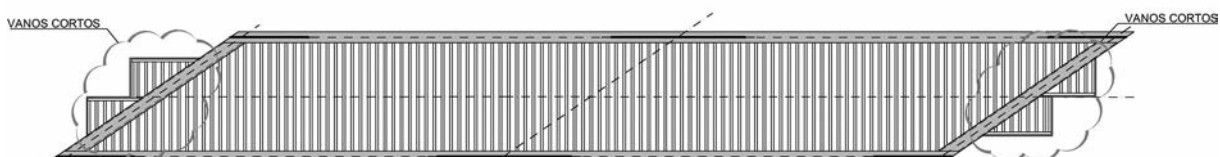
Planta del tablero con vanos cortos ortogonales al trazado
